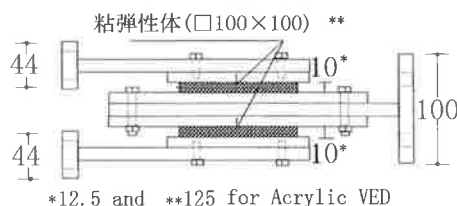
平板型粘弾性ダンパー小型試験体立面図 [単位:mm]
